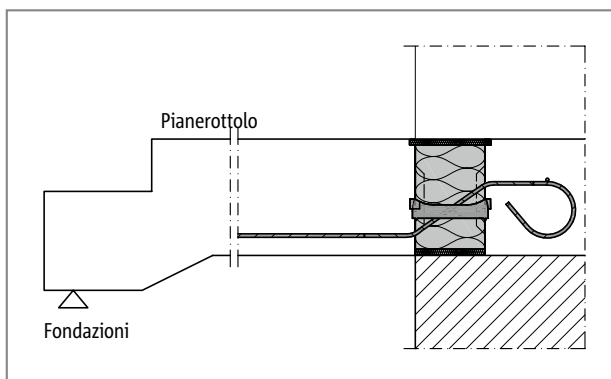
Schöck Isokorb® XT tipo QL: raccordo pianerottolo delle scale con appoggio su muratura termoisolante monostrato (XT tipo QL-V1 a V4)
